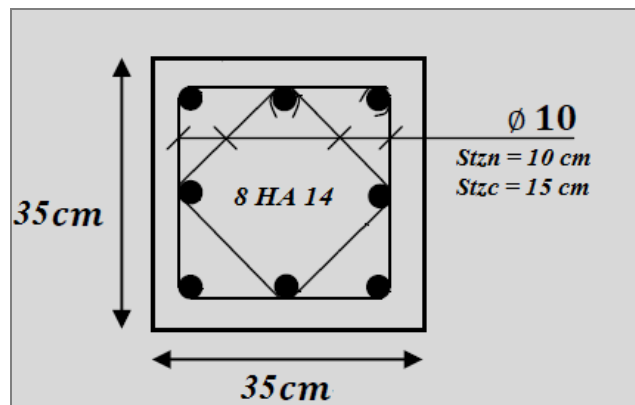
Schéma de ferrailage de poteau 35×35.
